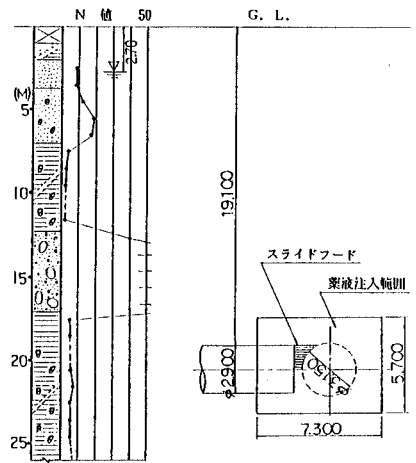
土質柱状図 図-2 薬液注入範囲図 単位(mm)
